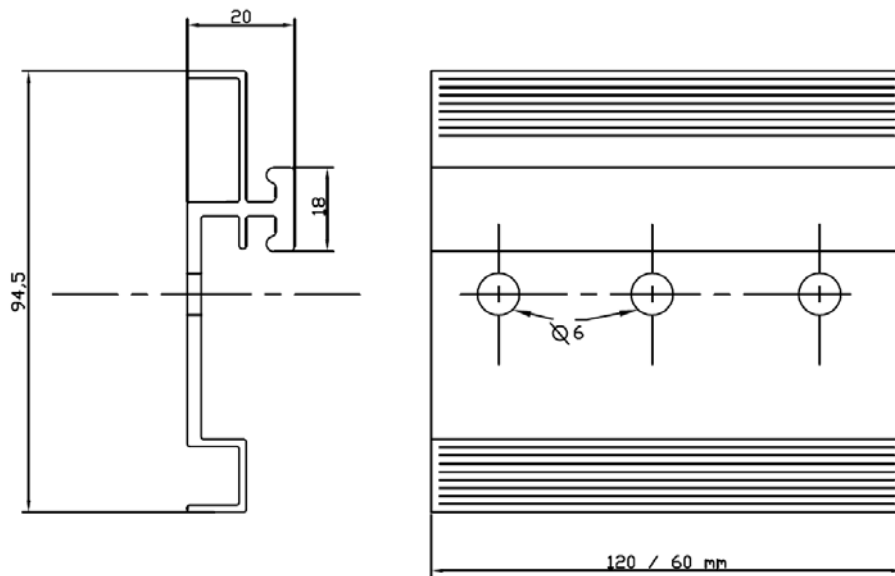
Coupe du panneau AKYVER Panel 60 (en mm)
